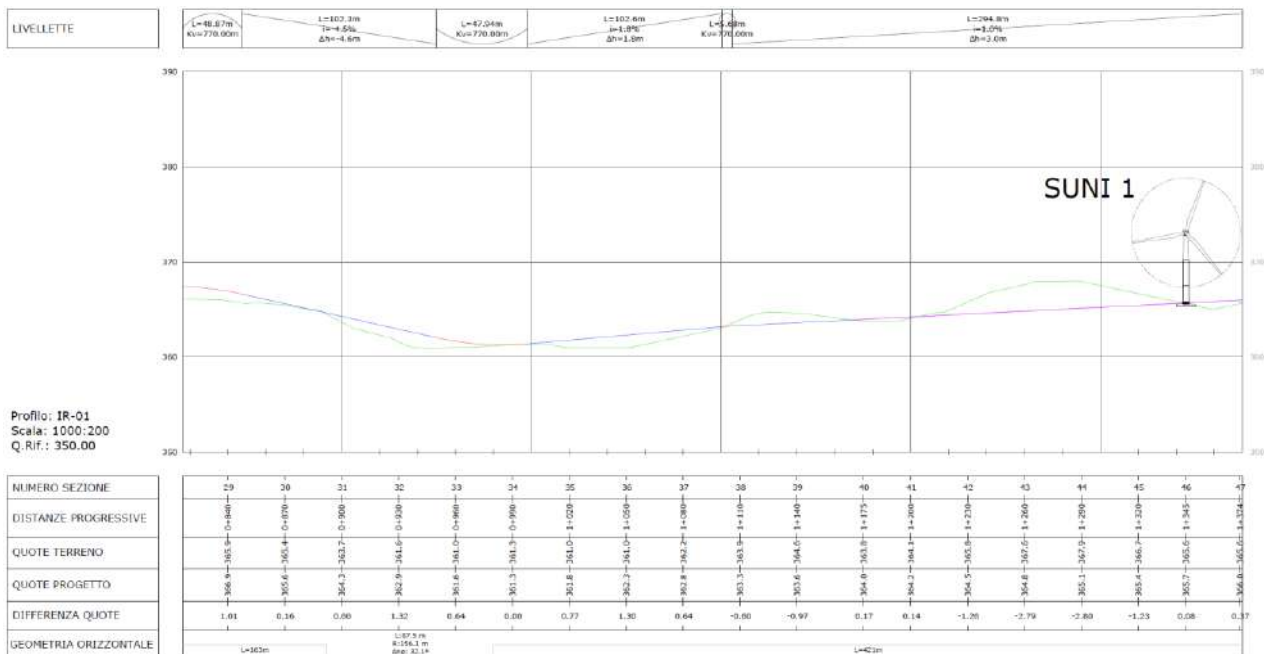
Profilo longitudinale tratto di viabilità di nuova realizzazione. Fonte: elaborato di progetto "C21BLN001DWD02200_Profilo longitudinali stradali e sezioni trasversali"
